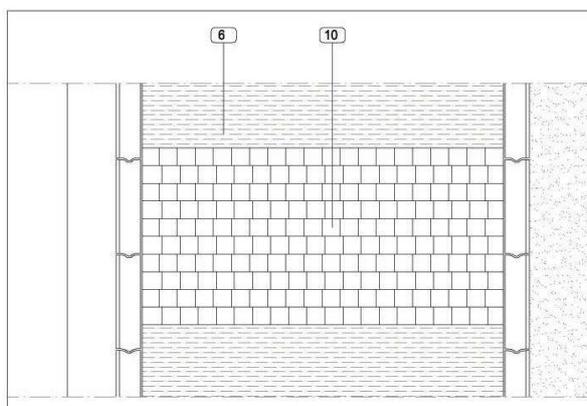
intervento di rifacimento di porzioni degradate della pavimentazione in asfalto pigmentato
